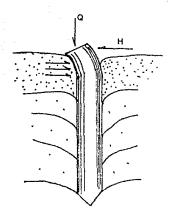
PILOTE CON CARGA HORIZONTAL.
